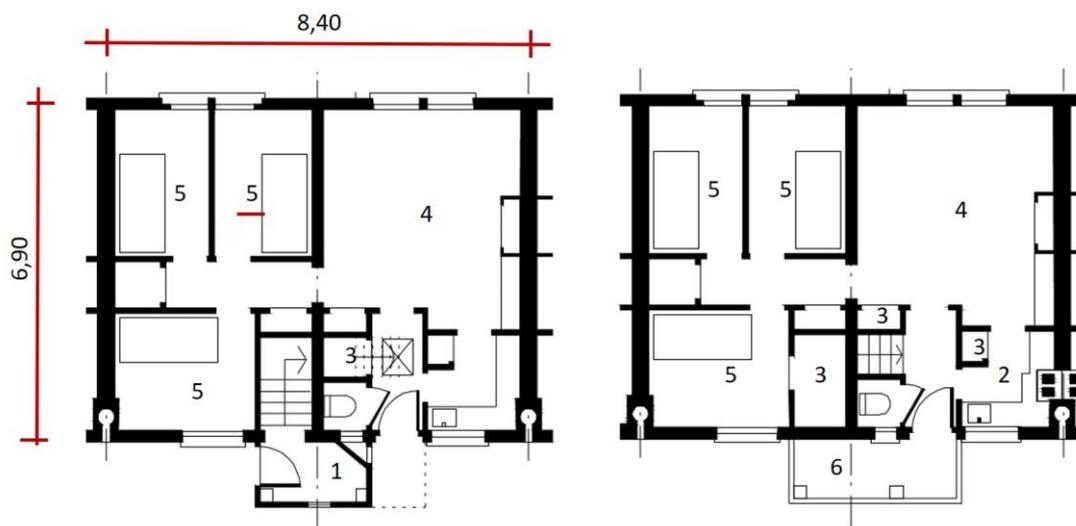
Planta baixa do térreo/Planta baixa do 2º pavimento.
